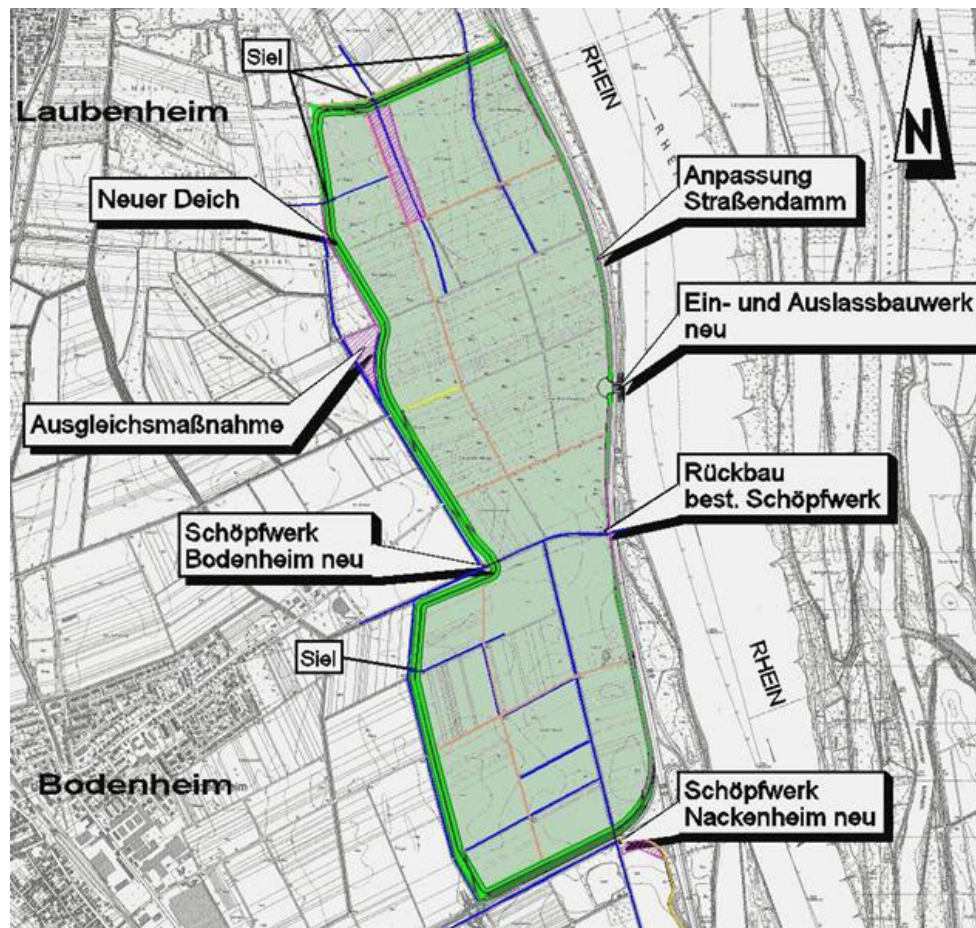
Lageplan der Hochwasserrückhaltung Bodenheim/ Laubenheim (SGD Süd)
